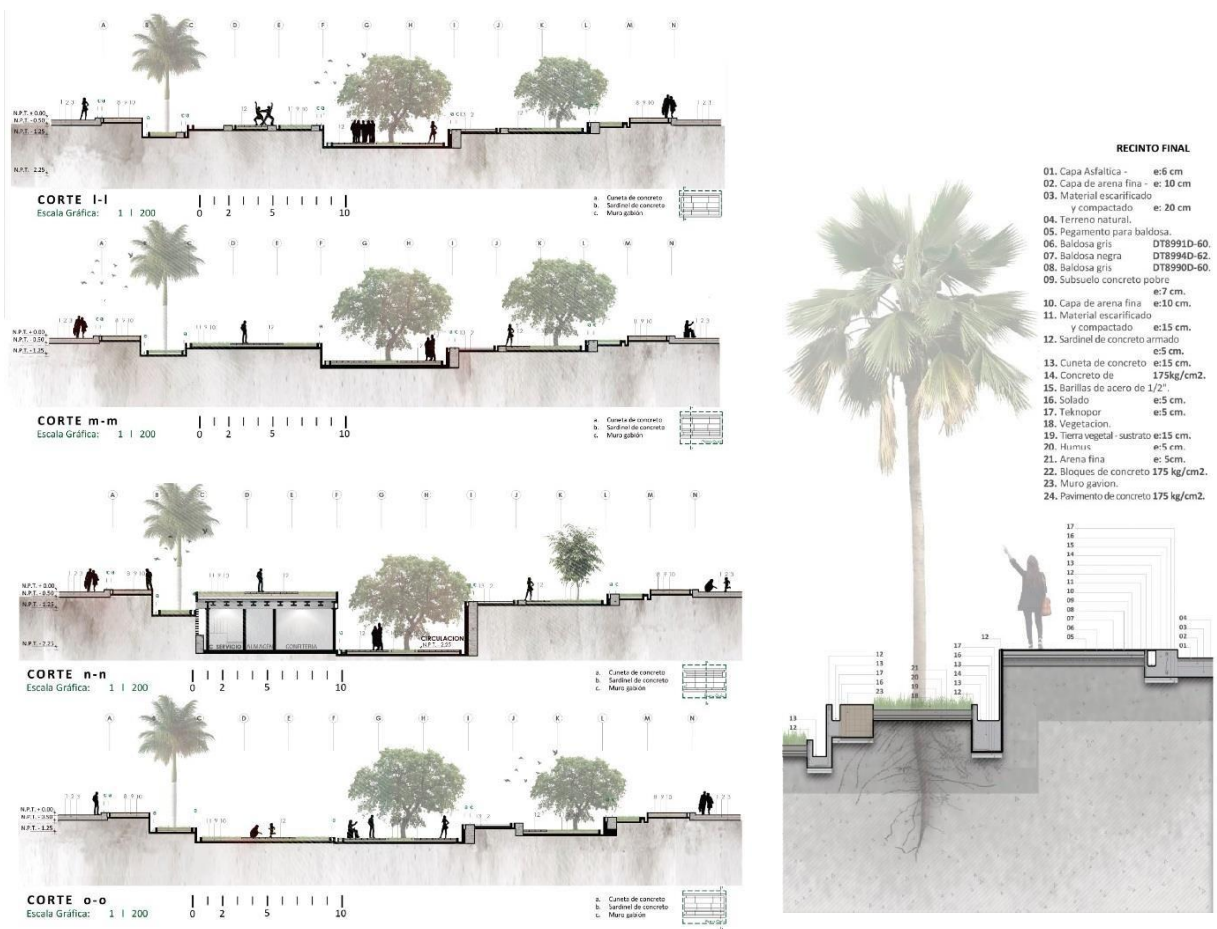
Esquema del Sector 05 + Cortes Transversales+ Detalle Constructivo.
